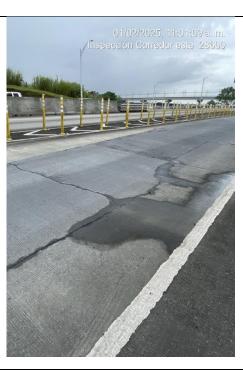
Vista de losas fracturadas y con desnivel 28k+ 600 Albrook @ Panamericana
